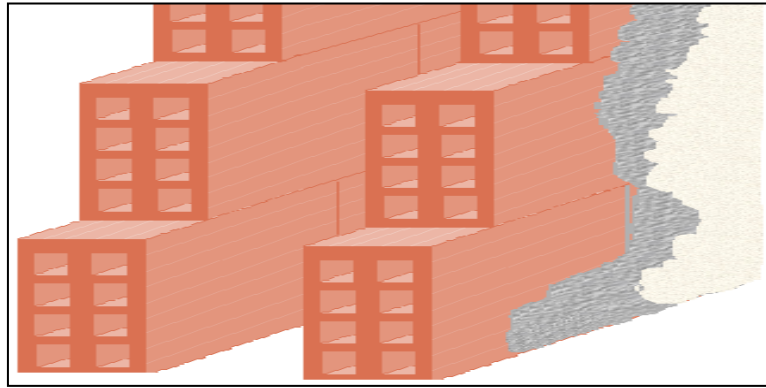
Coupe du mur extérieur (double Cloisons)
